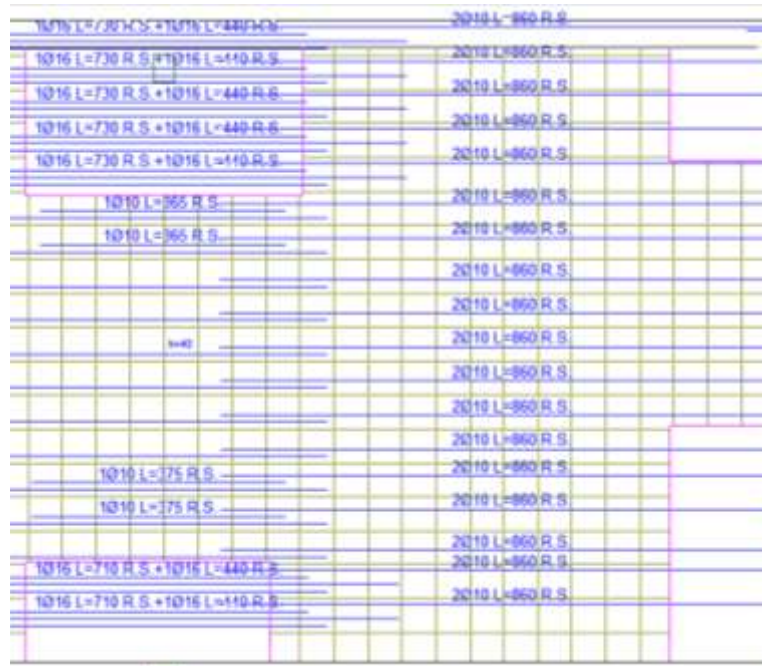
Grafica de las armaduras calculados en la losa reticular
